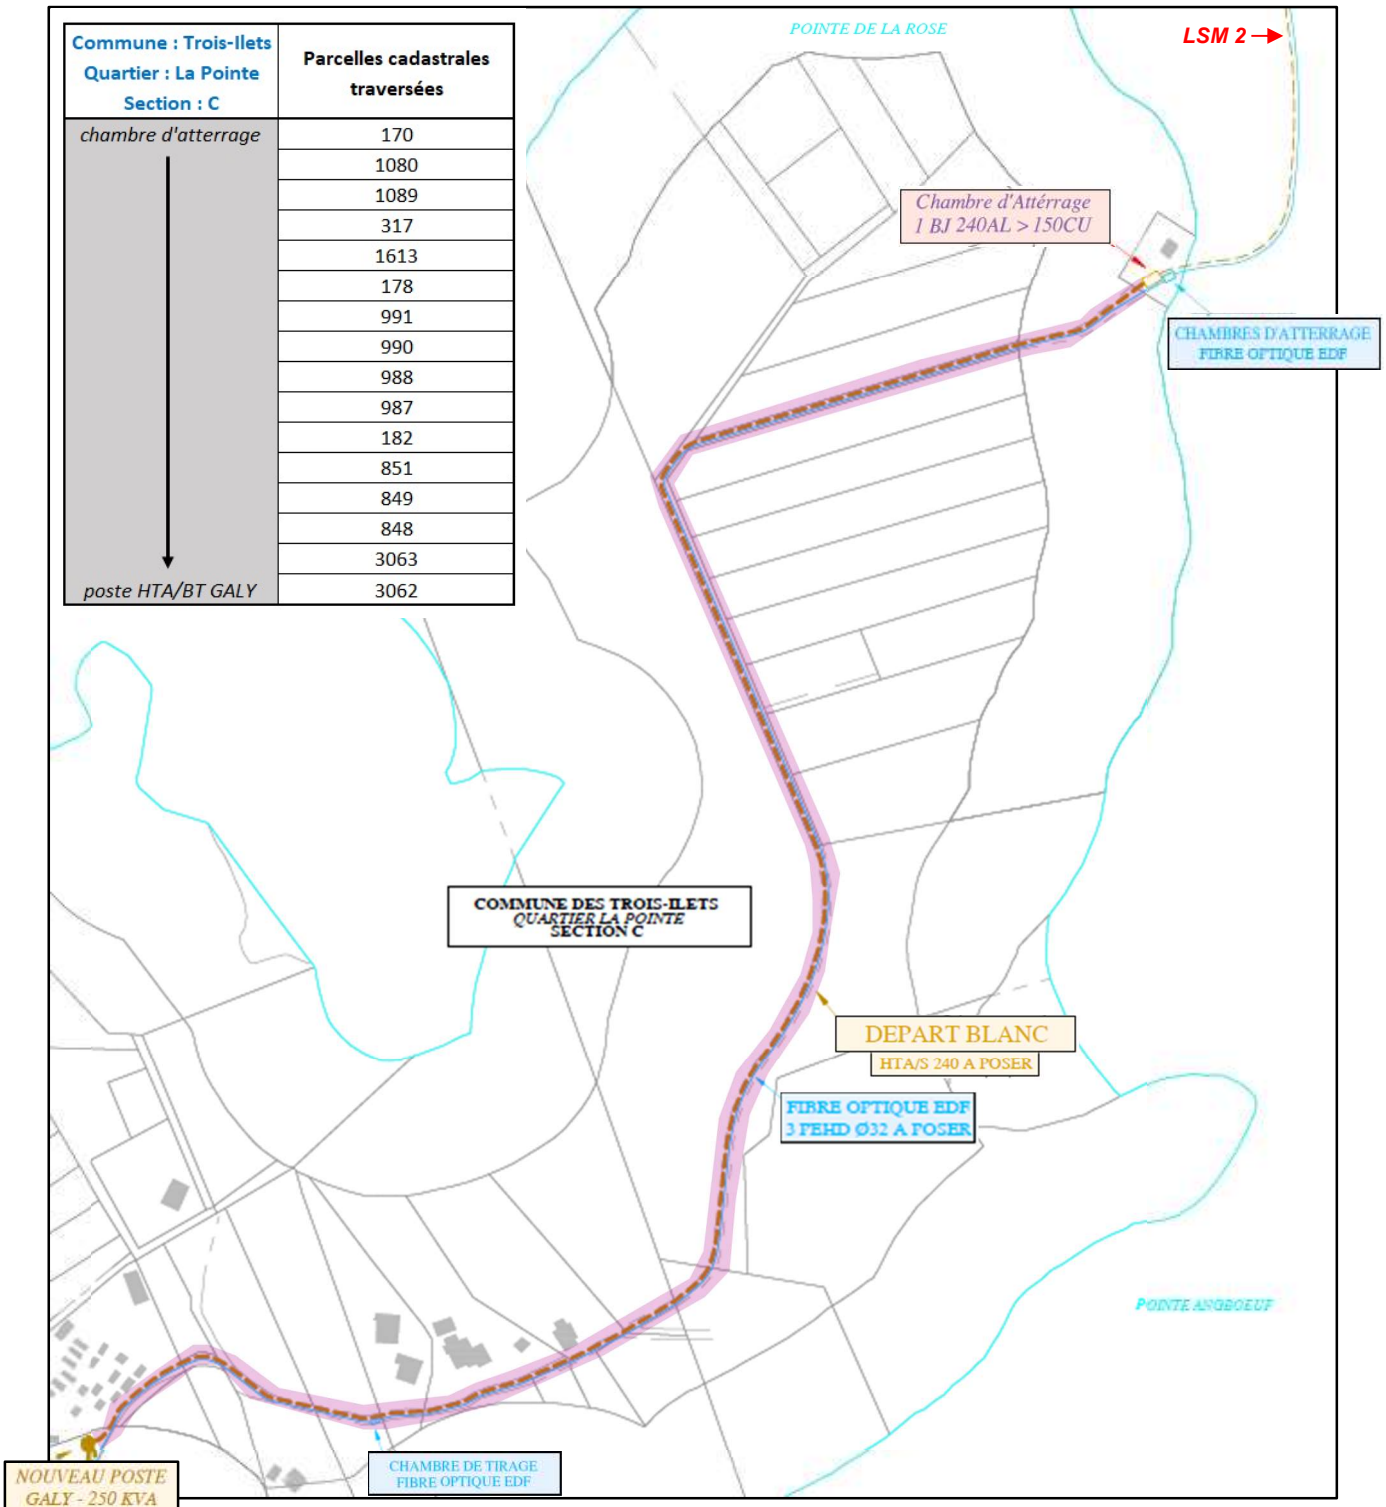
PLAN DE DETAIL DU TRACÉ (BANDE ROSE) DU RESEAU TERRESTRE LSM2 AU NIVEAU DE LA POINTE DE LA ROSE
